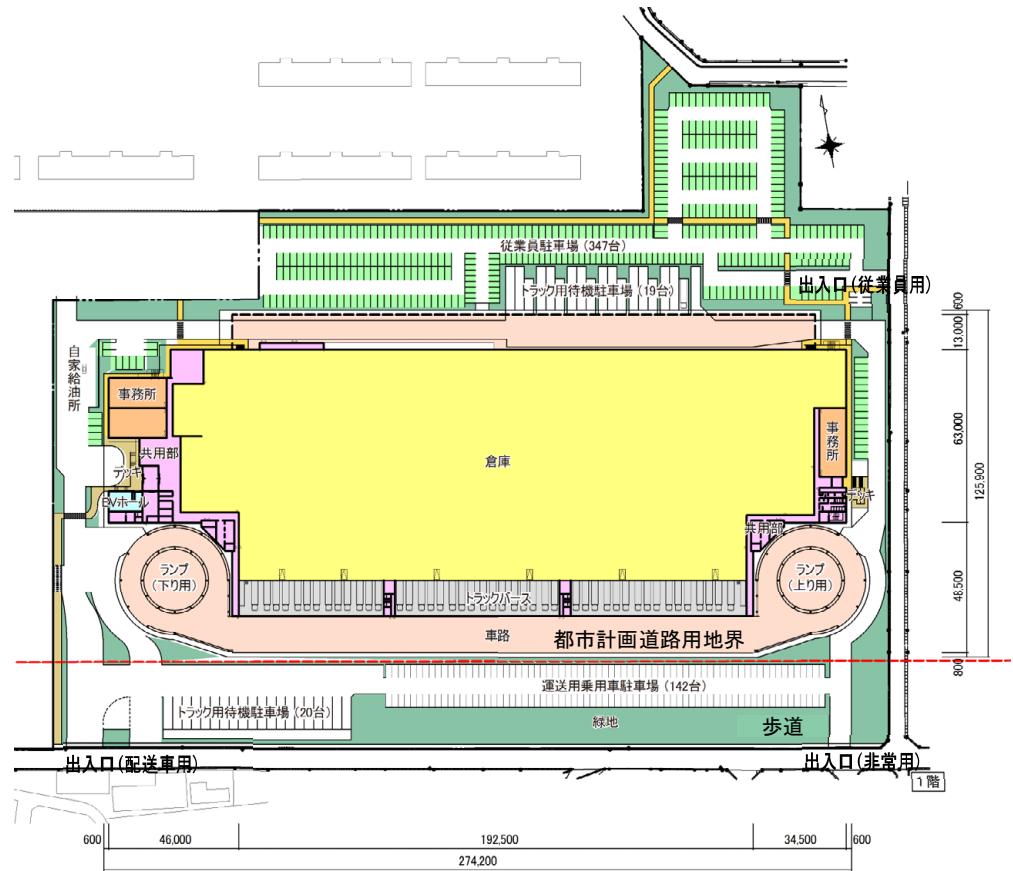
(1) 配置計画図兼 1 階平面図【変更前】
